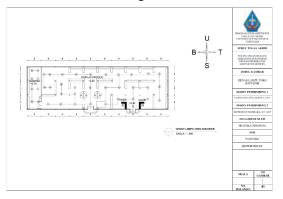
Denah Lampu Lantai 2 Kafetaria
